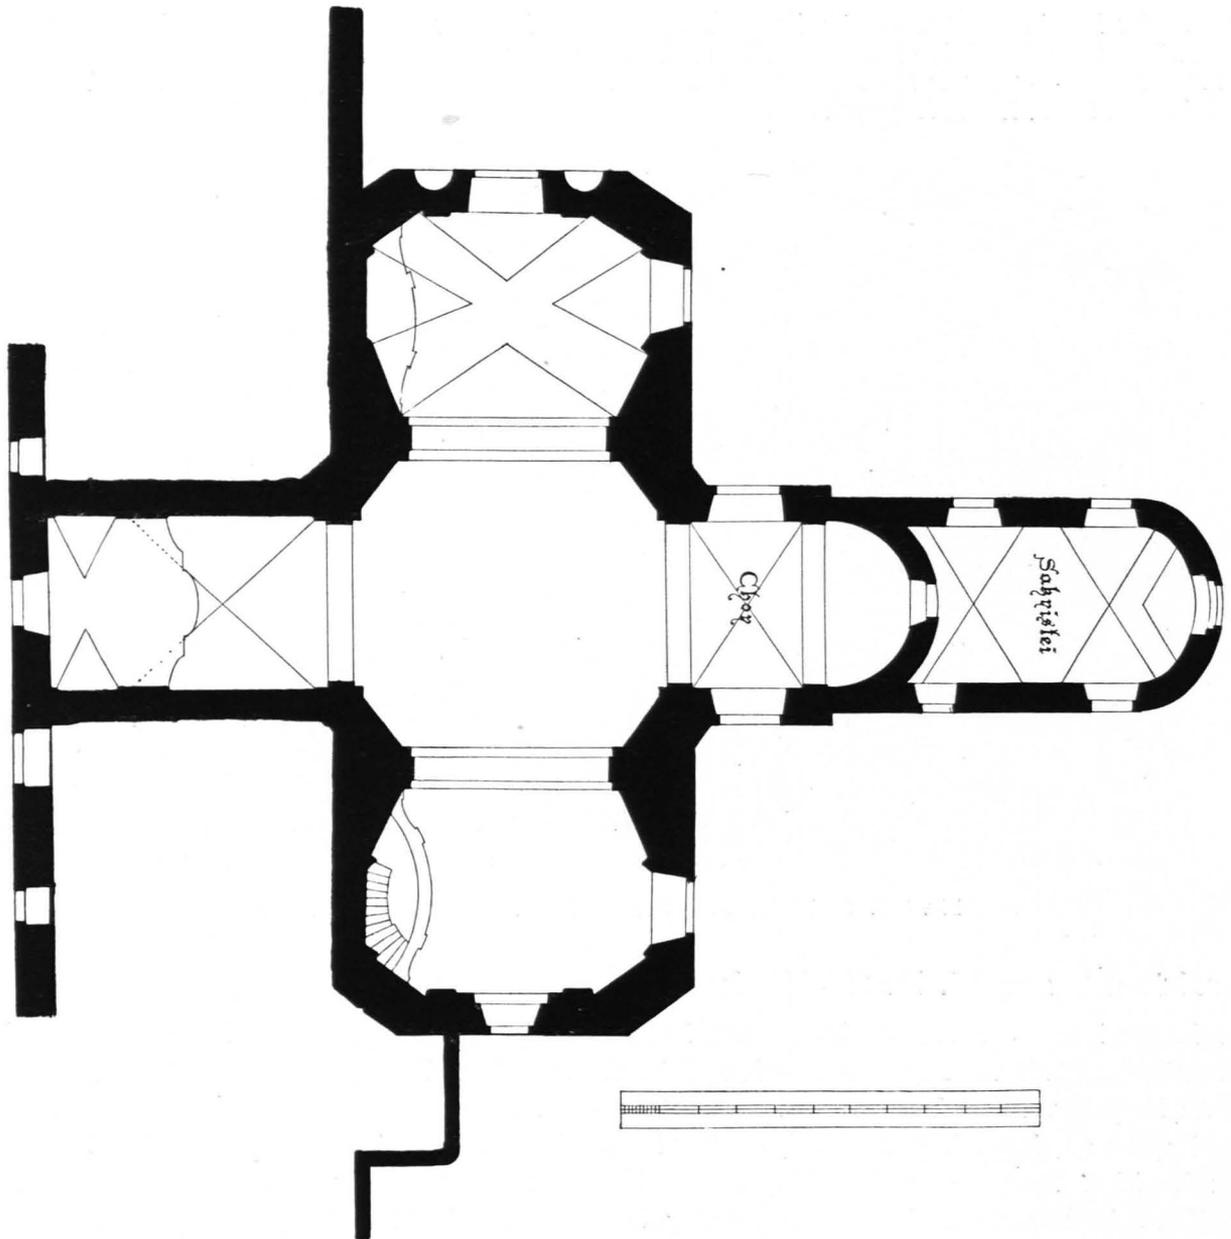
Schloß Rosenau, Pfarrkirche, Grundriß 1 : 200 (S. 386)
